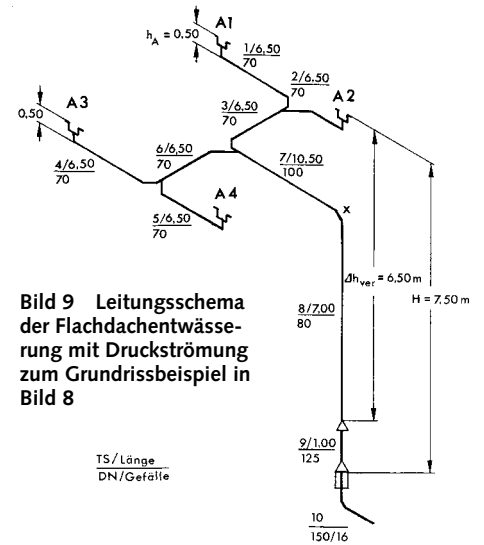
Leitungsschema der Flachdachentwässerung mit Druckströmung zum Grundrissbeispiel in Bild 8
